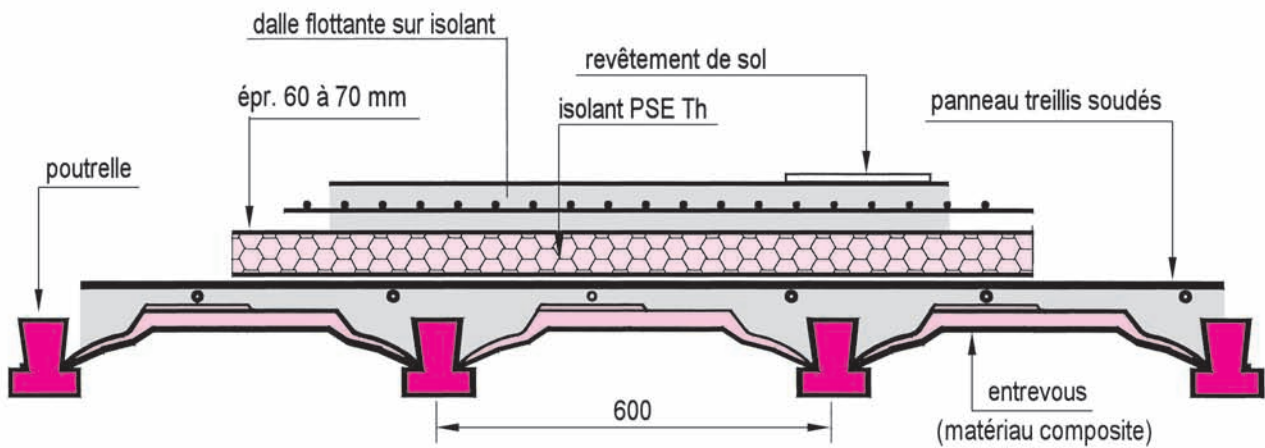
Plancher sur vide sanitaire avec dalle flottante sur isolant
